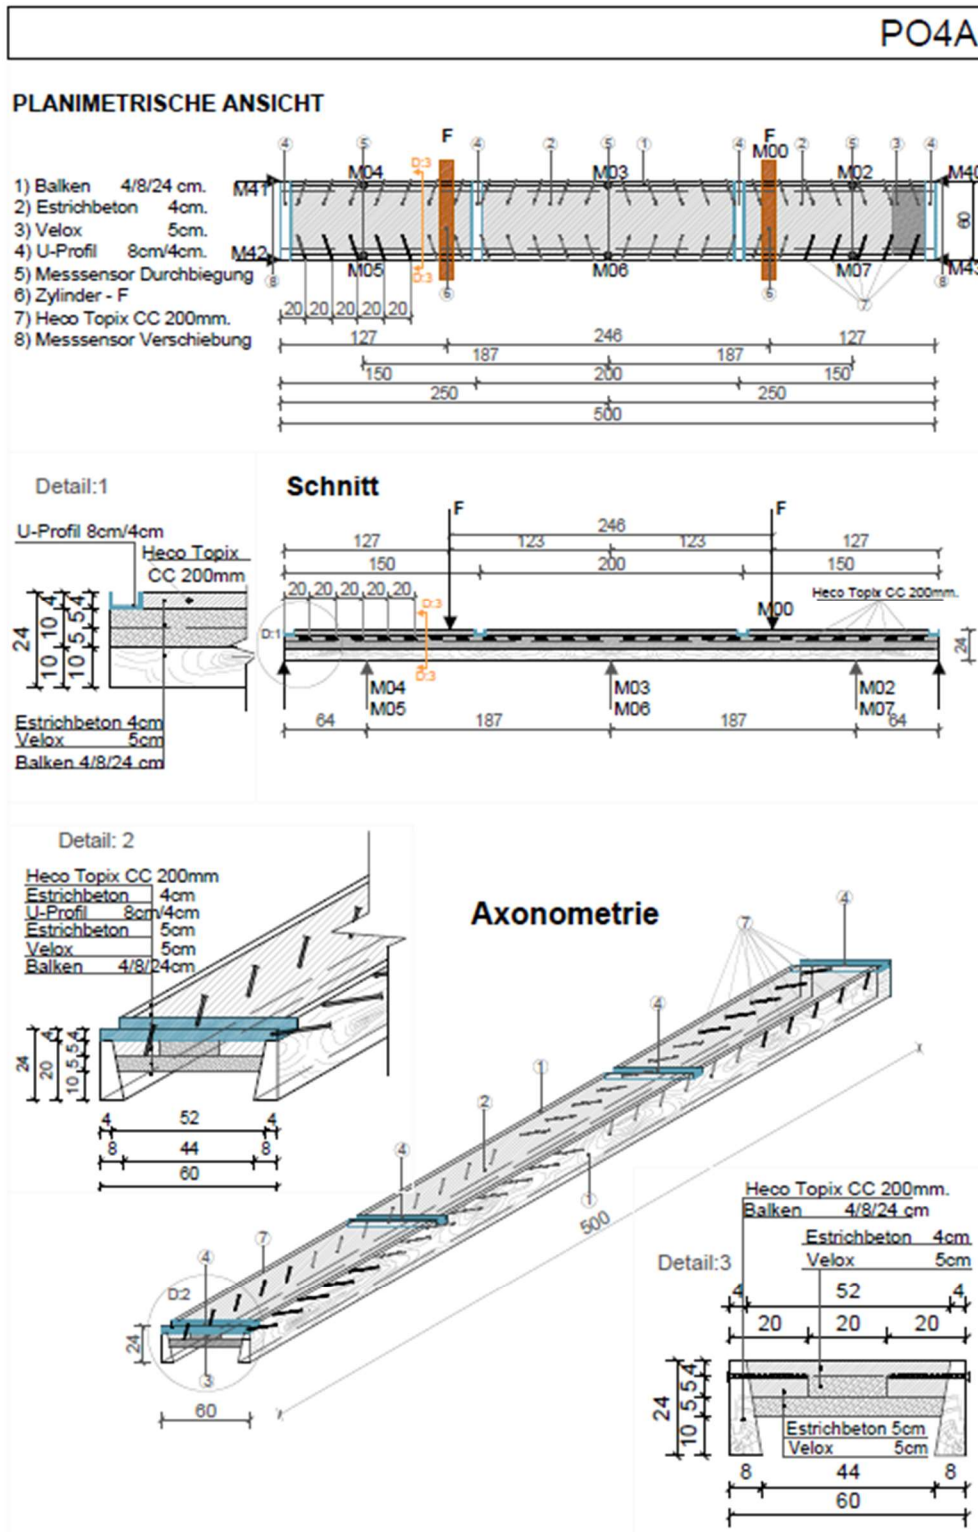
Planimetrische und axonometrische Darstellung des Bauteils P04A/P04B einschließlich der Bauteil-Schnitte.
